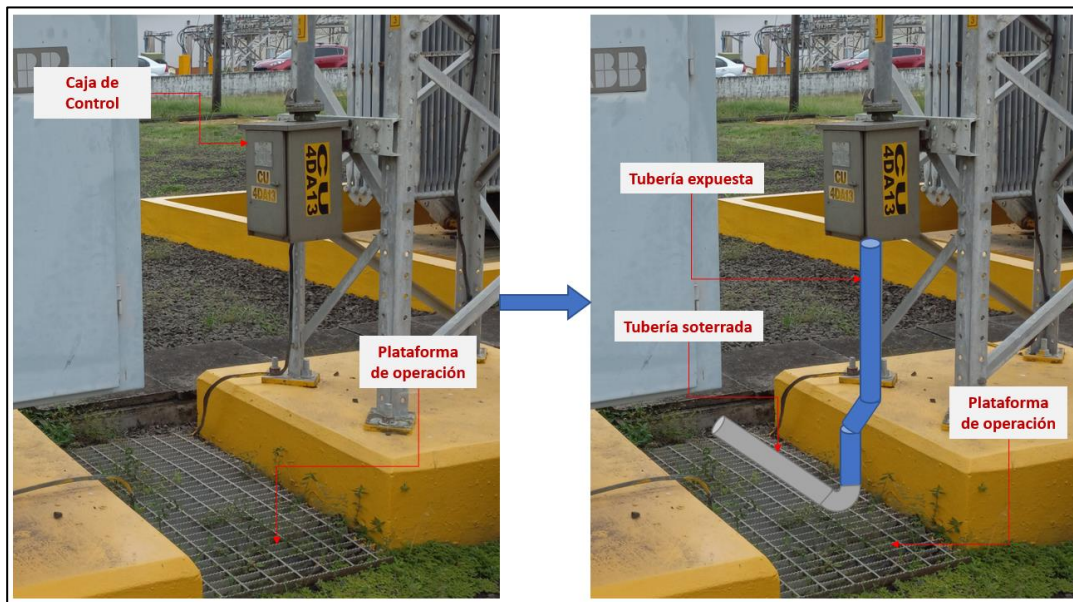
Concepto de instalación de tubería para CU 4DA13
